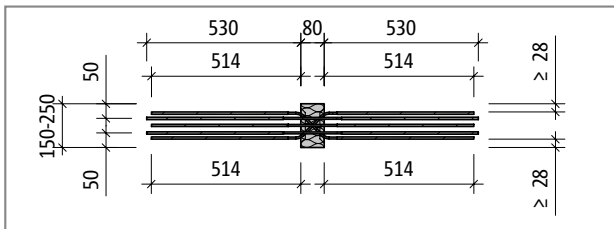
Schöck Isokorb® tipo W10S, pianta del prodotto
